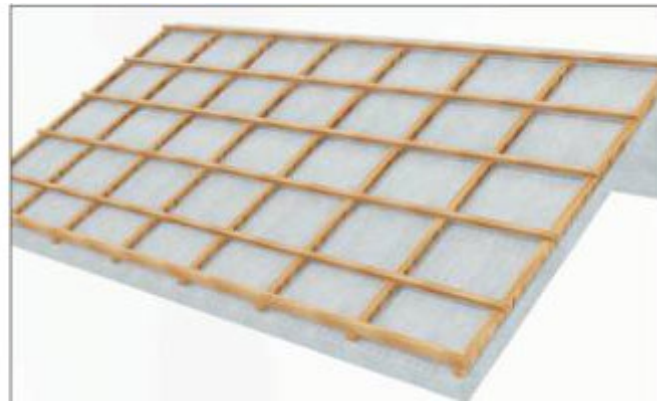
Установка рейки на бетонной крыше
